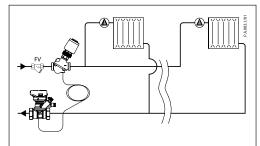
Die Steuerleitung muss vor dem Einbau durchgespült werden.
